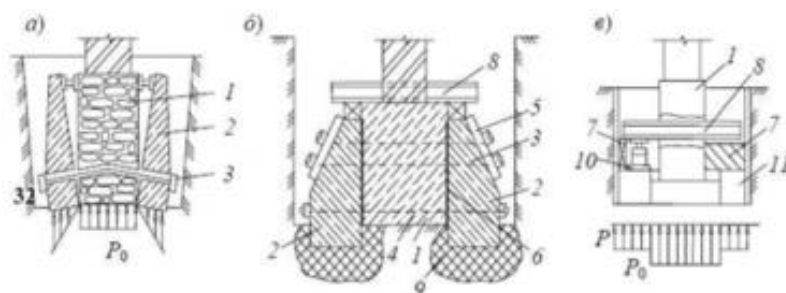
Варианты усиления с предварительным обжатием основания: 1 – фундамент; 2 – блоки; 3 – тяжи; 4 – фиксированная затяжка; 5 – прижимной щит; 6 – антифрикционное покрытие; 7 – клинья; 8 – поперечная балка; 9 – обжатое основание; 10 – домкрат; 11 – сборный банкет; 12 – бетон.
